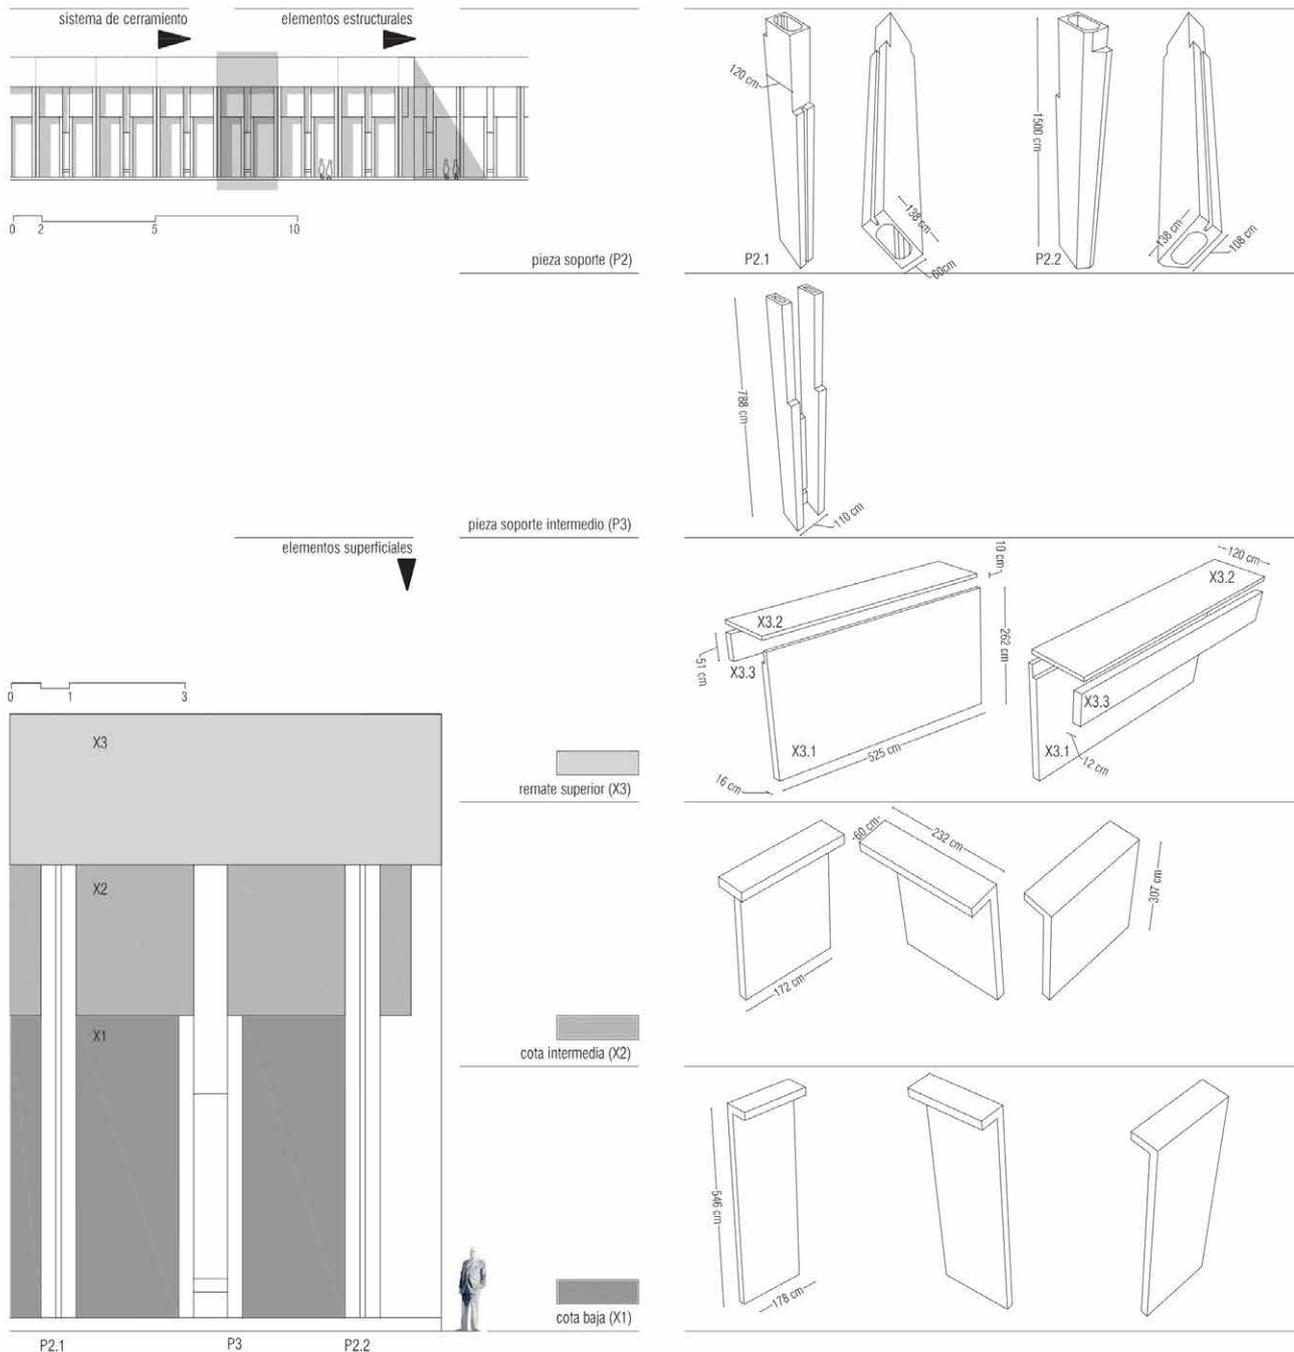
Alzado tipo y despiece de elementos de fachada. Fuente: Elaboración propia.
